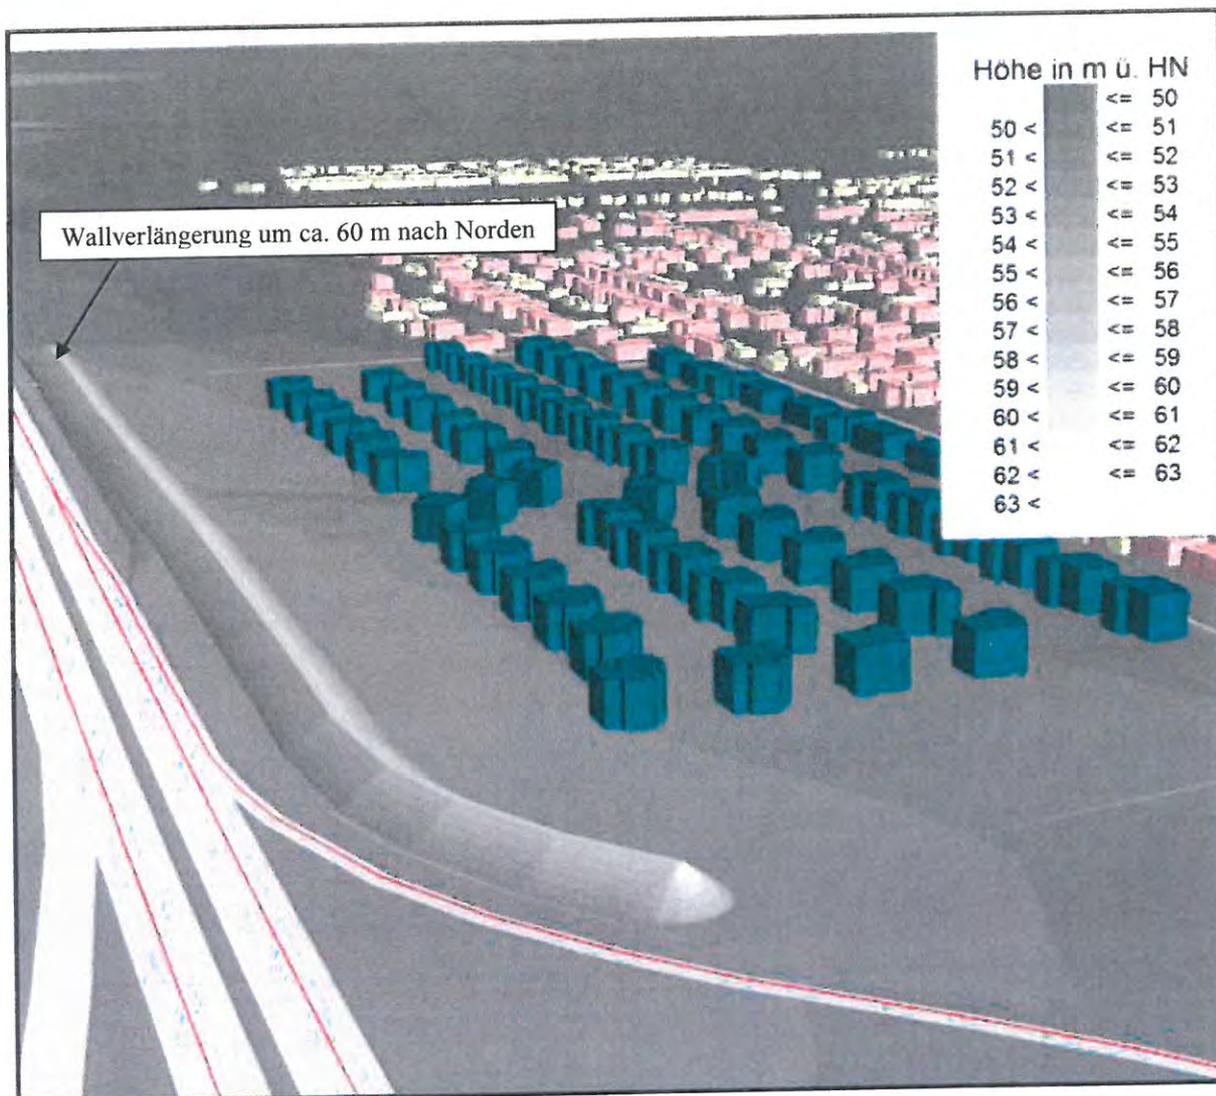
Zu untersuchende Variante eines 560 m langen Lärmschutzwalls im Lageplan des Berechnungsmodells (Vogelperspektive mit Blickrichtung nach Nordosten)
